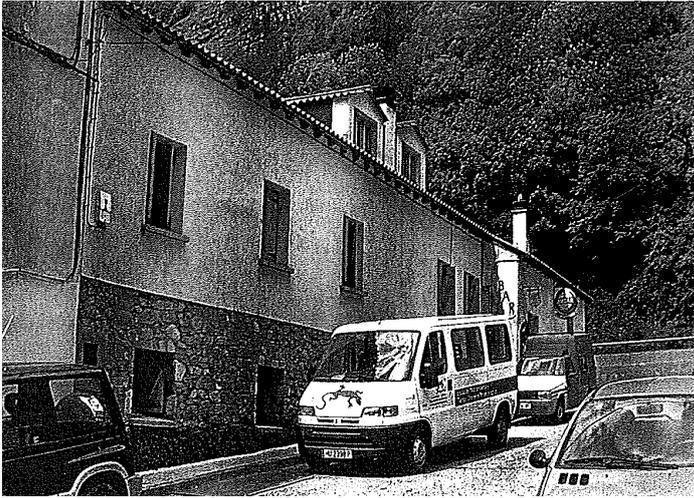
Imagen de la edificación. Calle Ramón y Cajal
